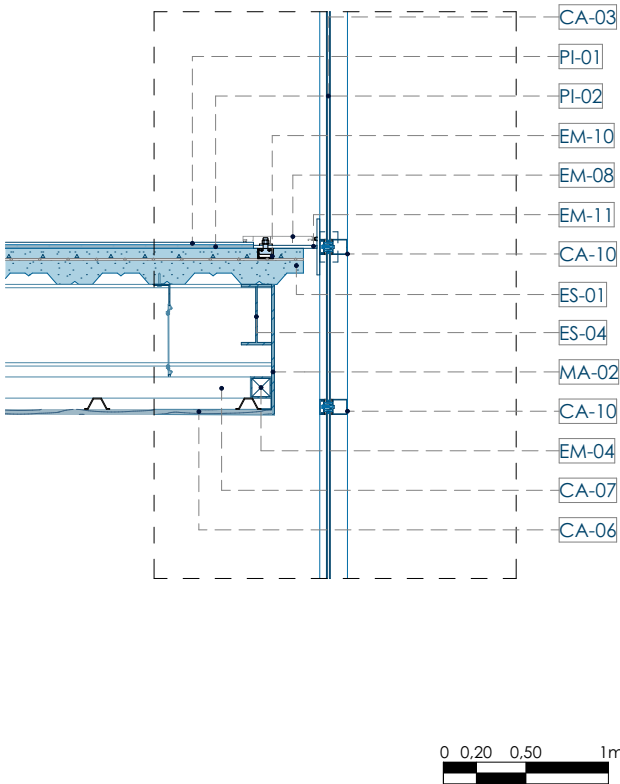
Detalle constructivo 06. Nota. Elaboración propia.
